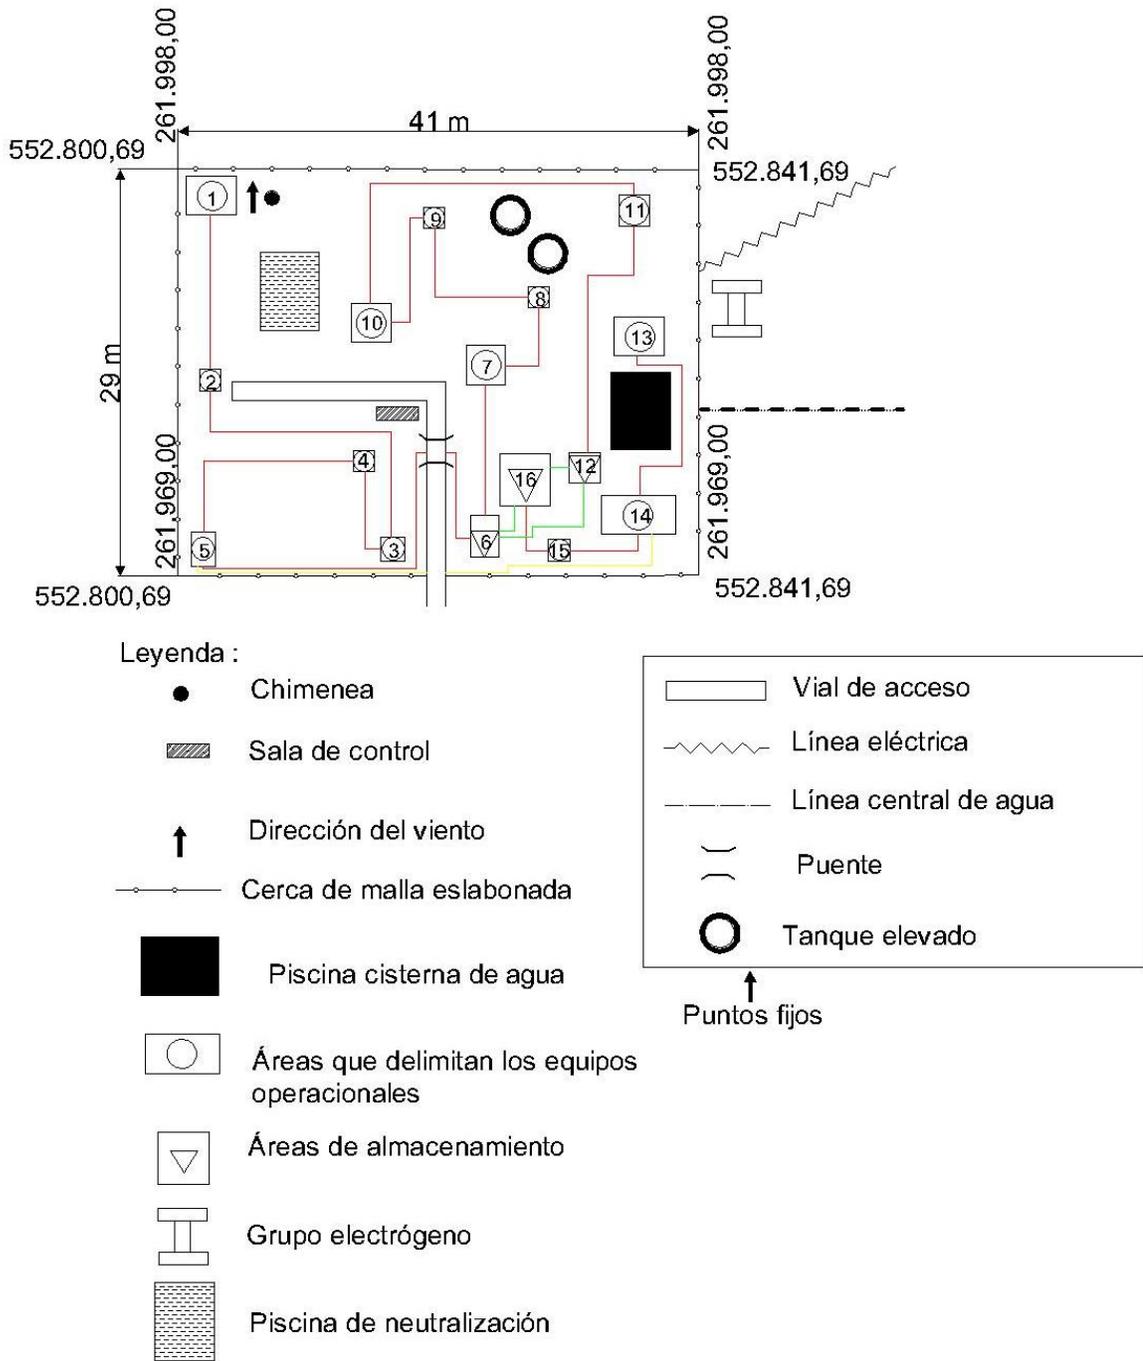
Alternativa 3 del plan general. Fuente: Elaboración propia.
